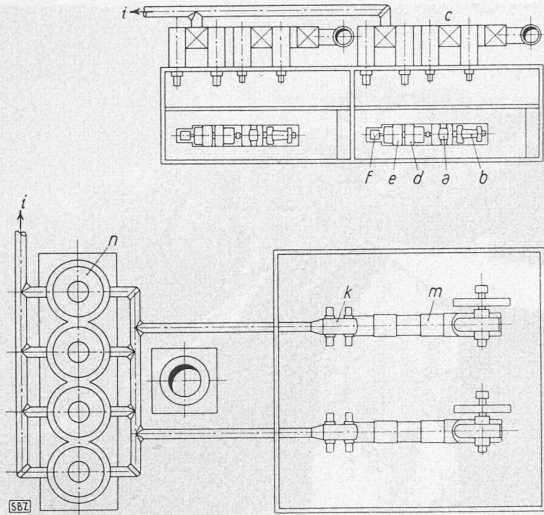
Platzbedarf der Heizkraft-Luftturbine (oben) im Verhältnis zu dem einer Anlage mit Gasmotor, Kolbengebläse und Cowpern. m Gasmotor-Zylinder, k Kolbengebläse, n Cowper, übrige Bezeichnungen siehe Bild 19. Masstab 1:1000
